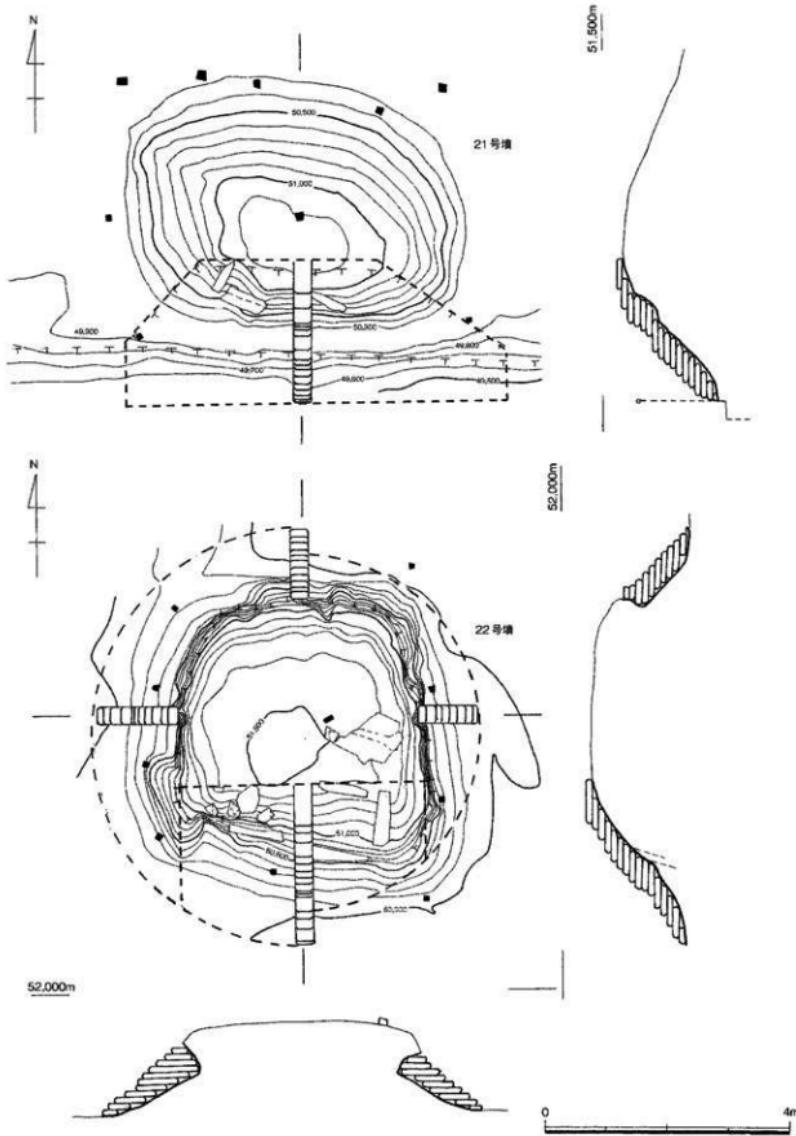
国史跡南方古墳群第21・22号墳上塗積み計画平面・断面図 (1/80)
